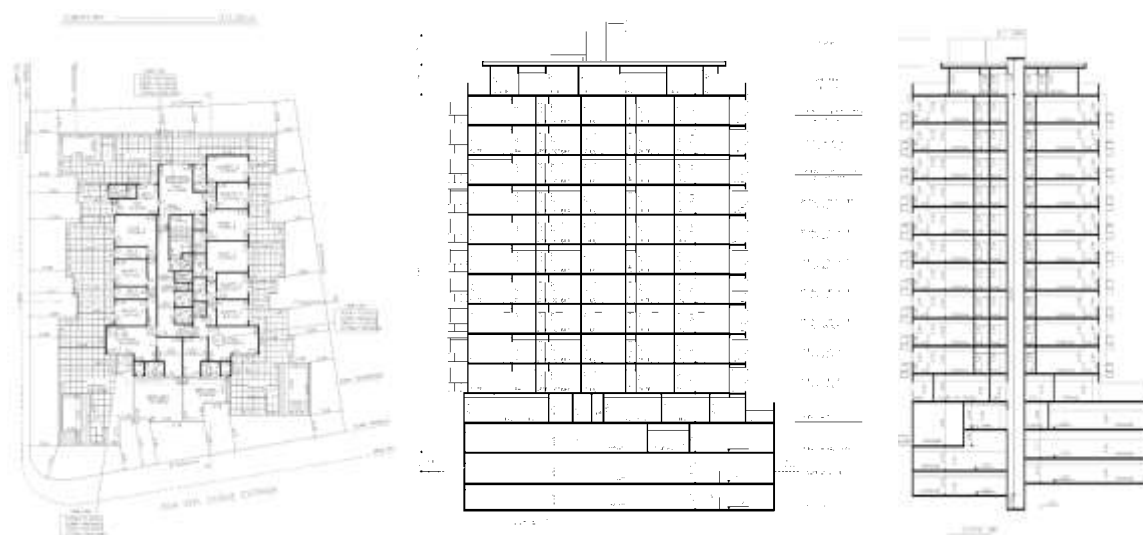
Cobertura, Corte AA e Corte BB – Fonte: Projeto Legal
